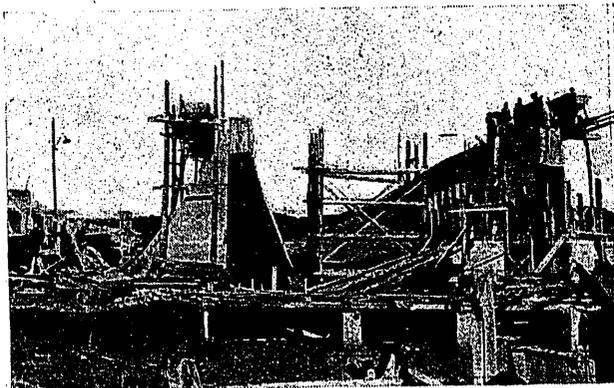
Canal. Construcción de la zona de contrafuertes.
